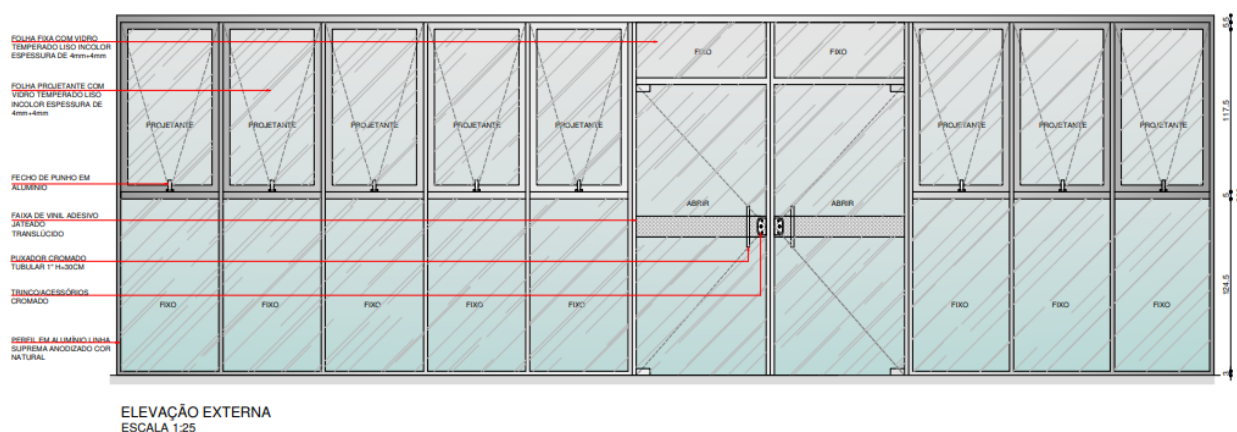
Elevação externa – Conjunto de vidro da fachada
